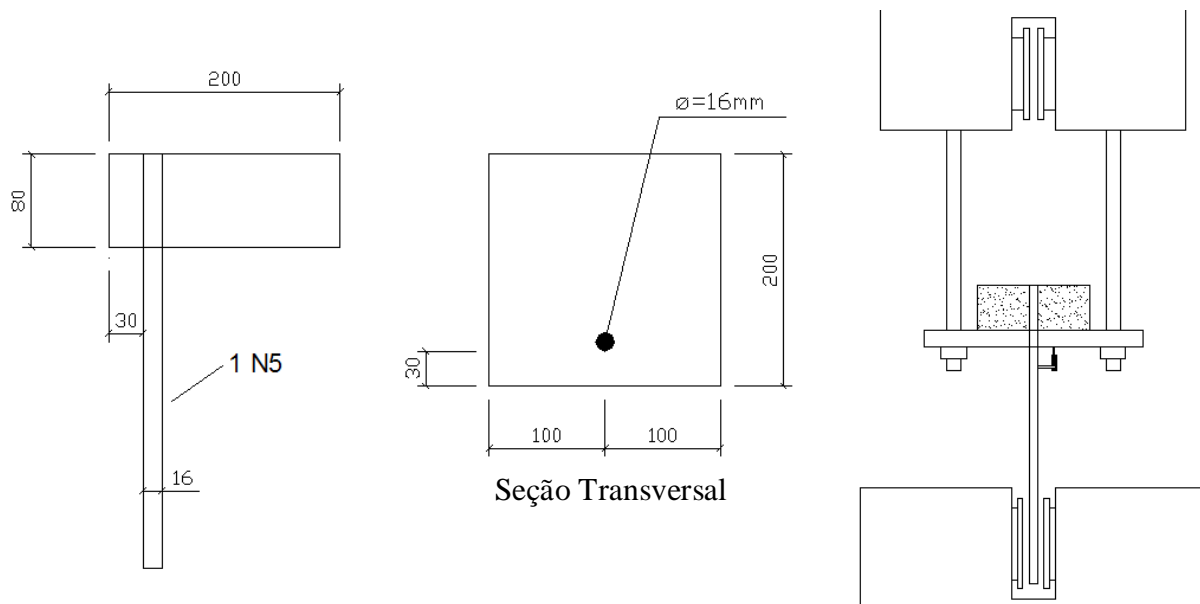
Formas do modelo de arrancamento com barras retas de 16 mm (dimensões em mm)
